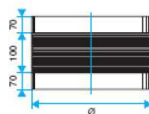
Exemple de pièce de raccordement préfabriquée entre caisson et conduit (document ALDES)
